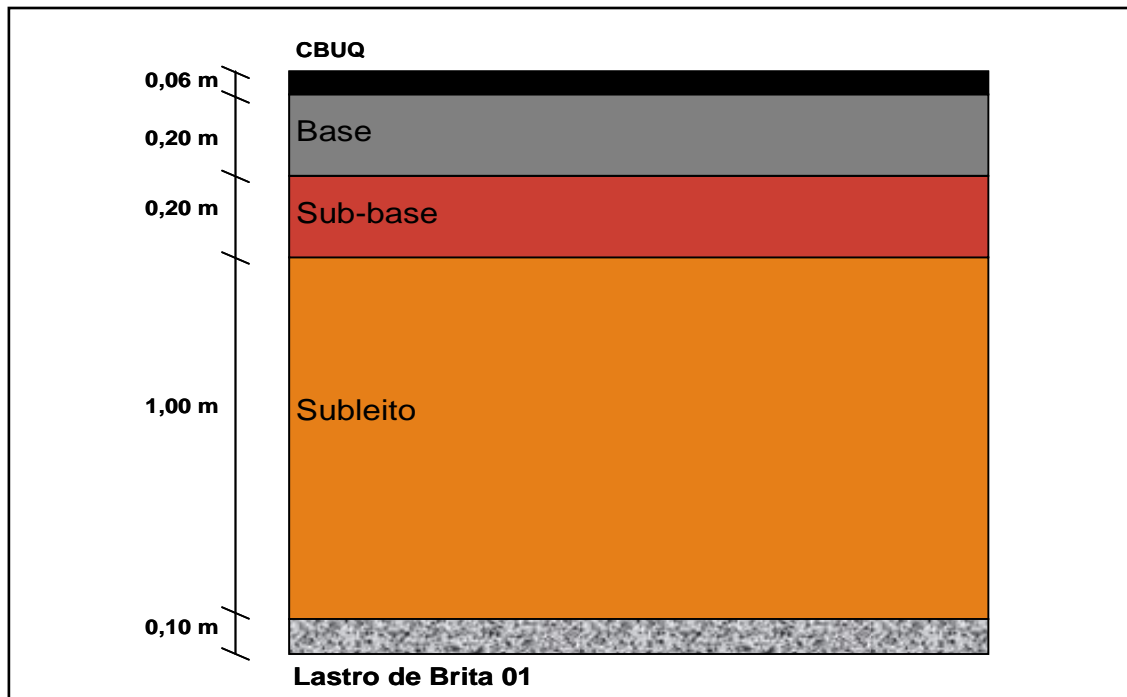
Estrutura proposta de pavimento para o estudo desta tese.
